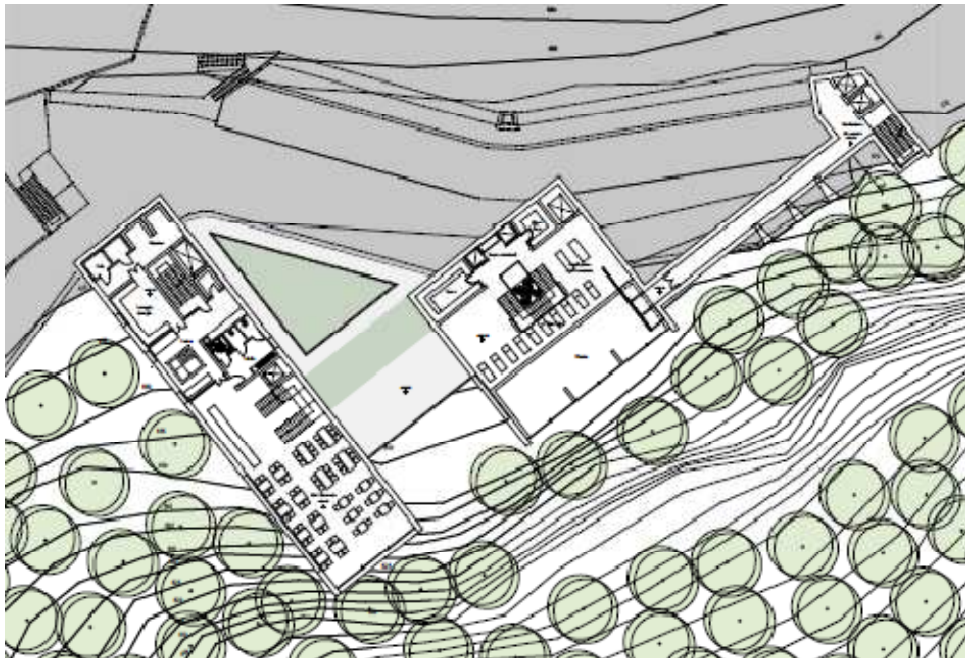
piante del piano terra del ristorante e della spa con collegamento alle camere
